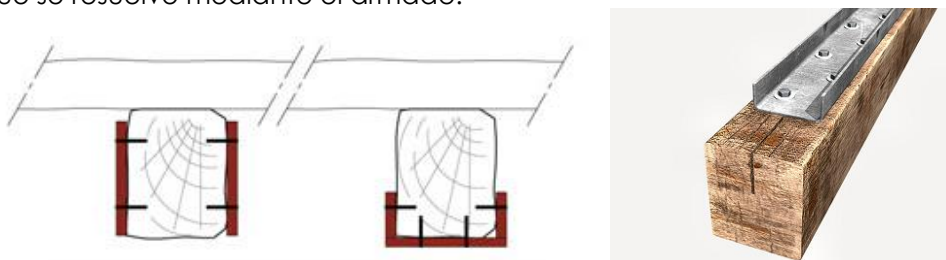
Disposiciones de distintas pletinas adosadas a una viga de madera.
